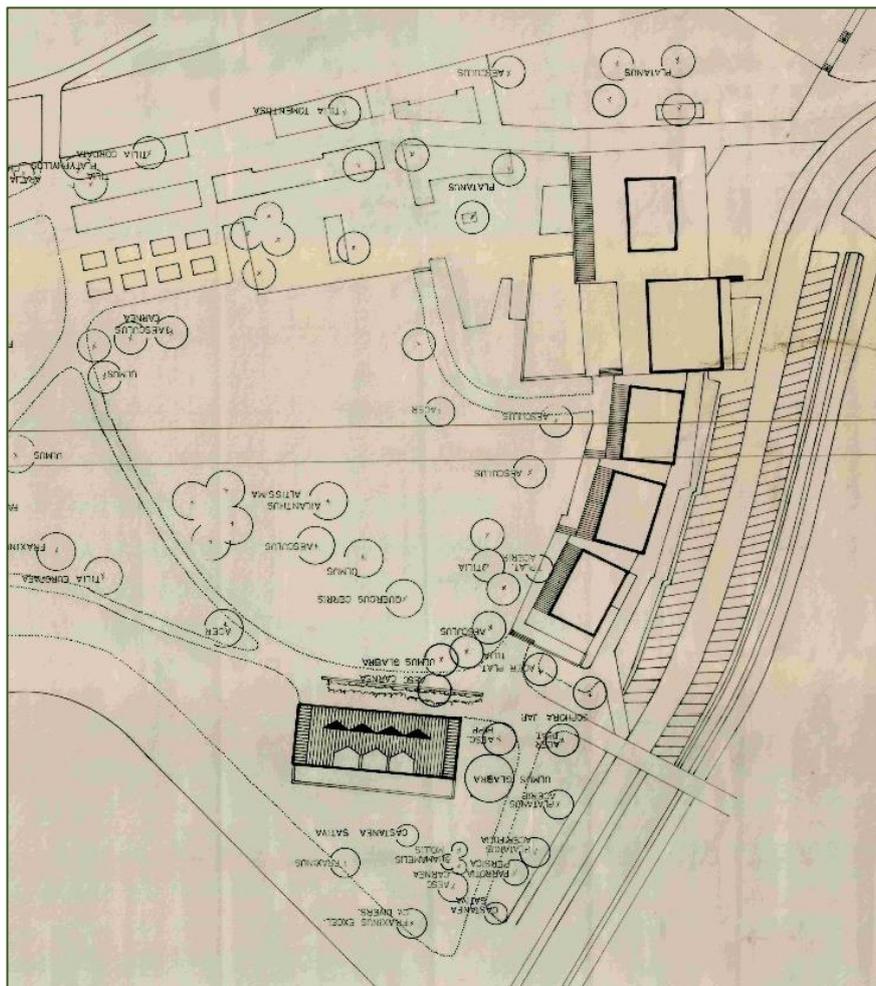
Bestandsplan Stadtpark 1963, Ausschnitt
